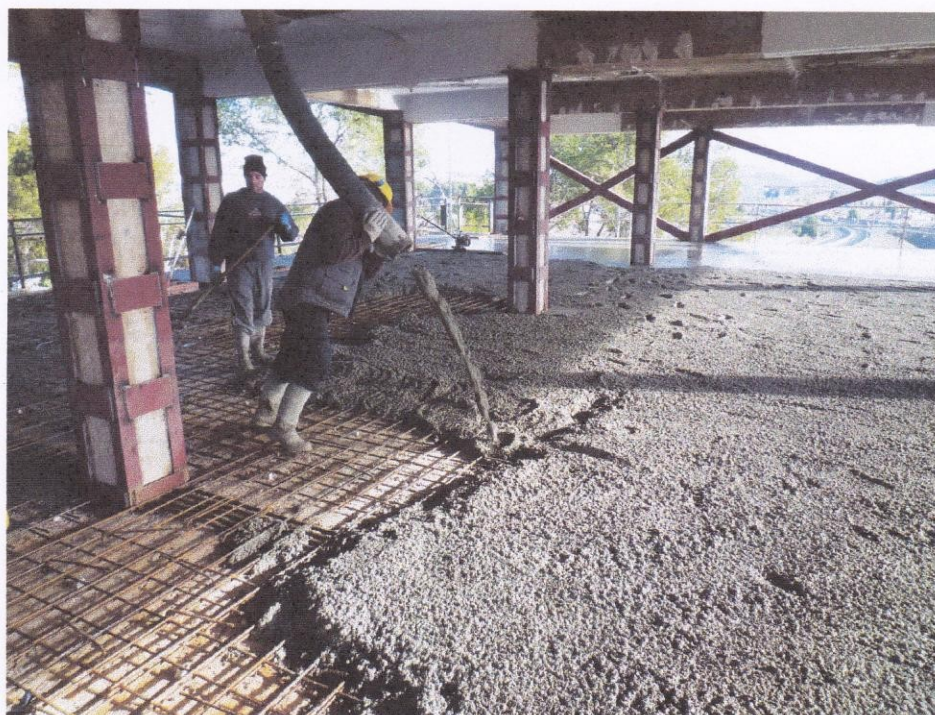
y 6 (01/12/10): reparación de las vigas de cimentación del edificio T.
